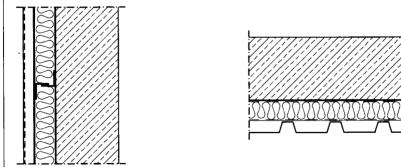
Außenwandbekleidung mit Wärmedämmung vor Beton- oder Mauerwerkswand
